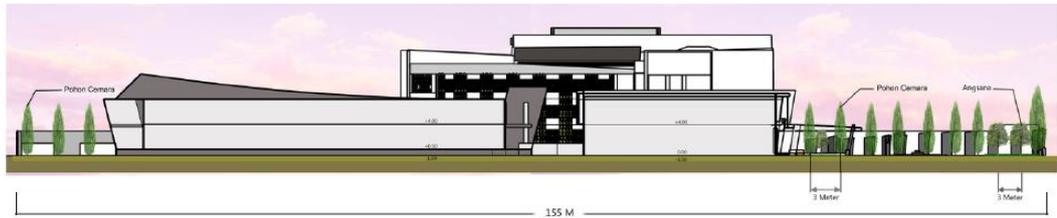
26 Potongan Bangunan Area Pelatihan & Belajar
